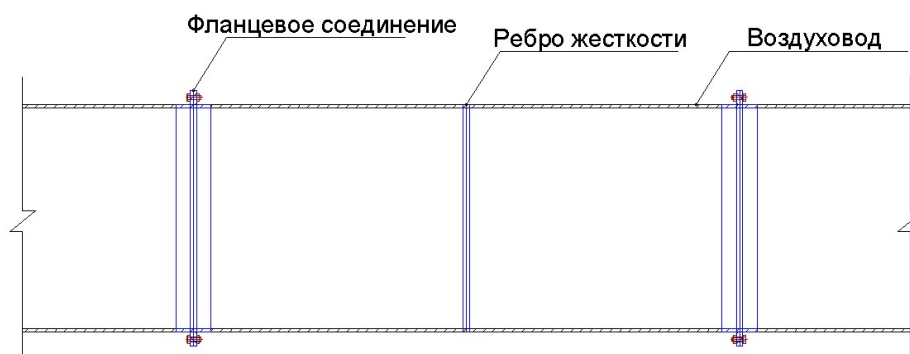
Принципиальная схема конструкции воздуховода из оцинкованной стали на фланцевых соединениях
